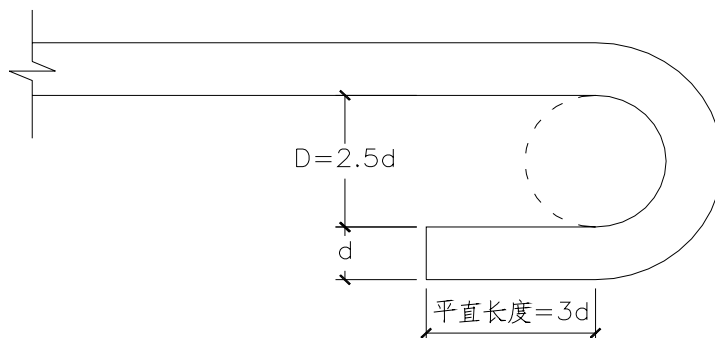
I 级钢筋弯钩尺寸示意图 1
